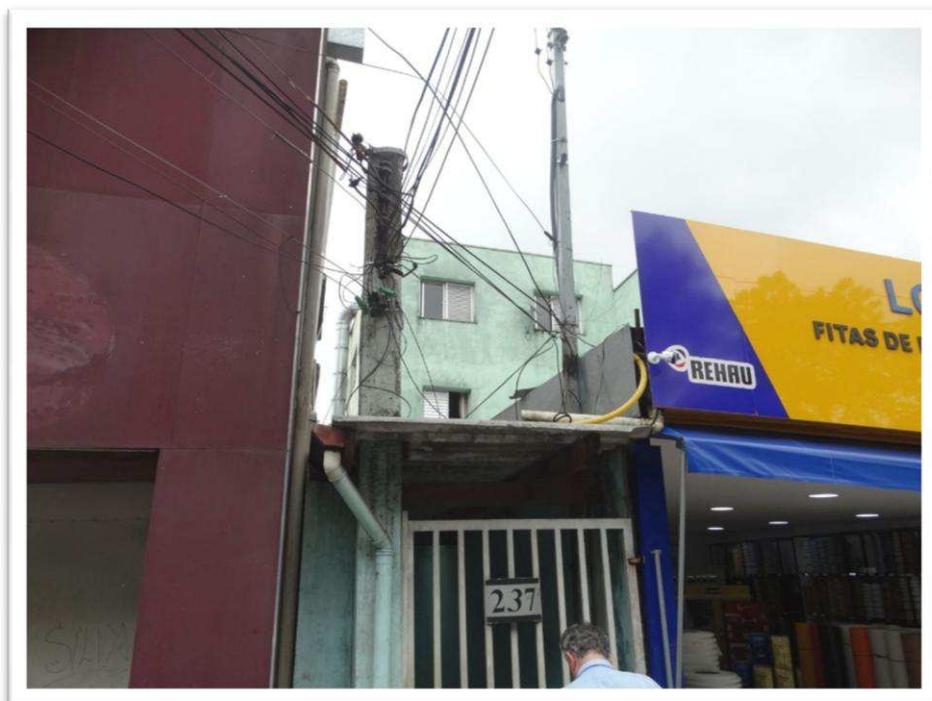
Vista parcial externa do imóvel objeto da vistoria – Portão de acesso à área dos apartamentos.
